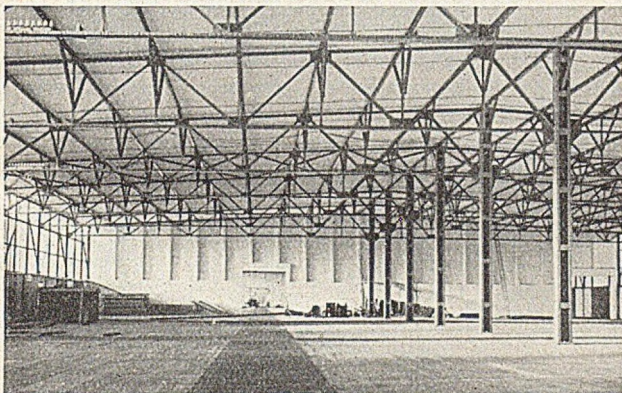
Schuppen 74, Stahlfachwerkbauweise.
